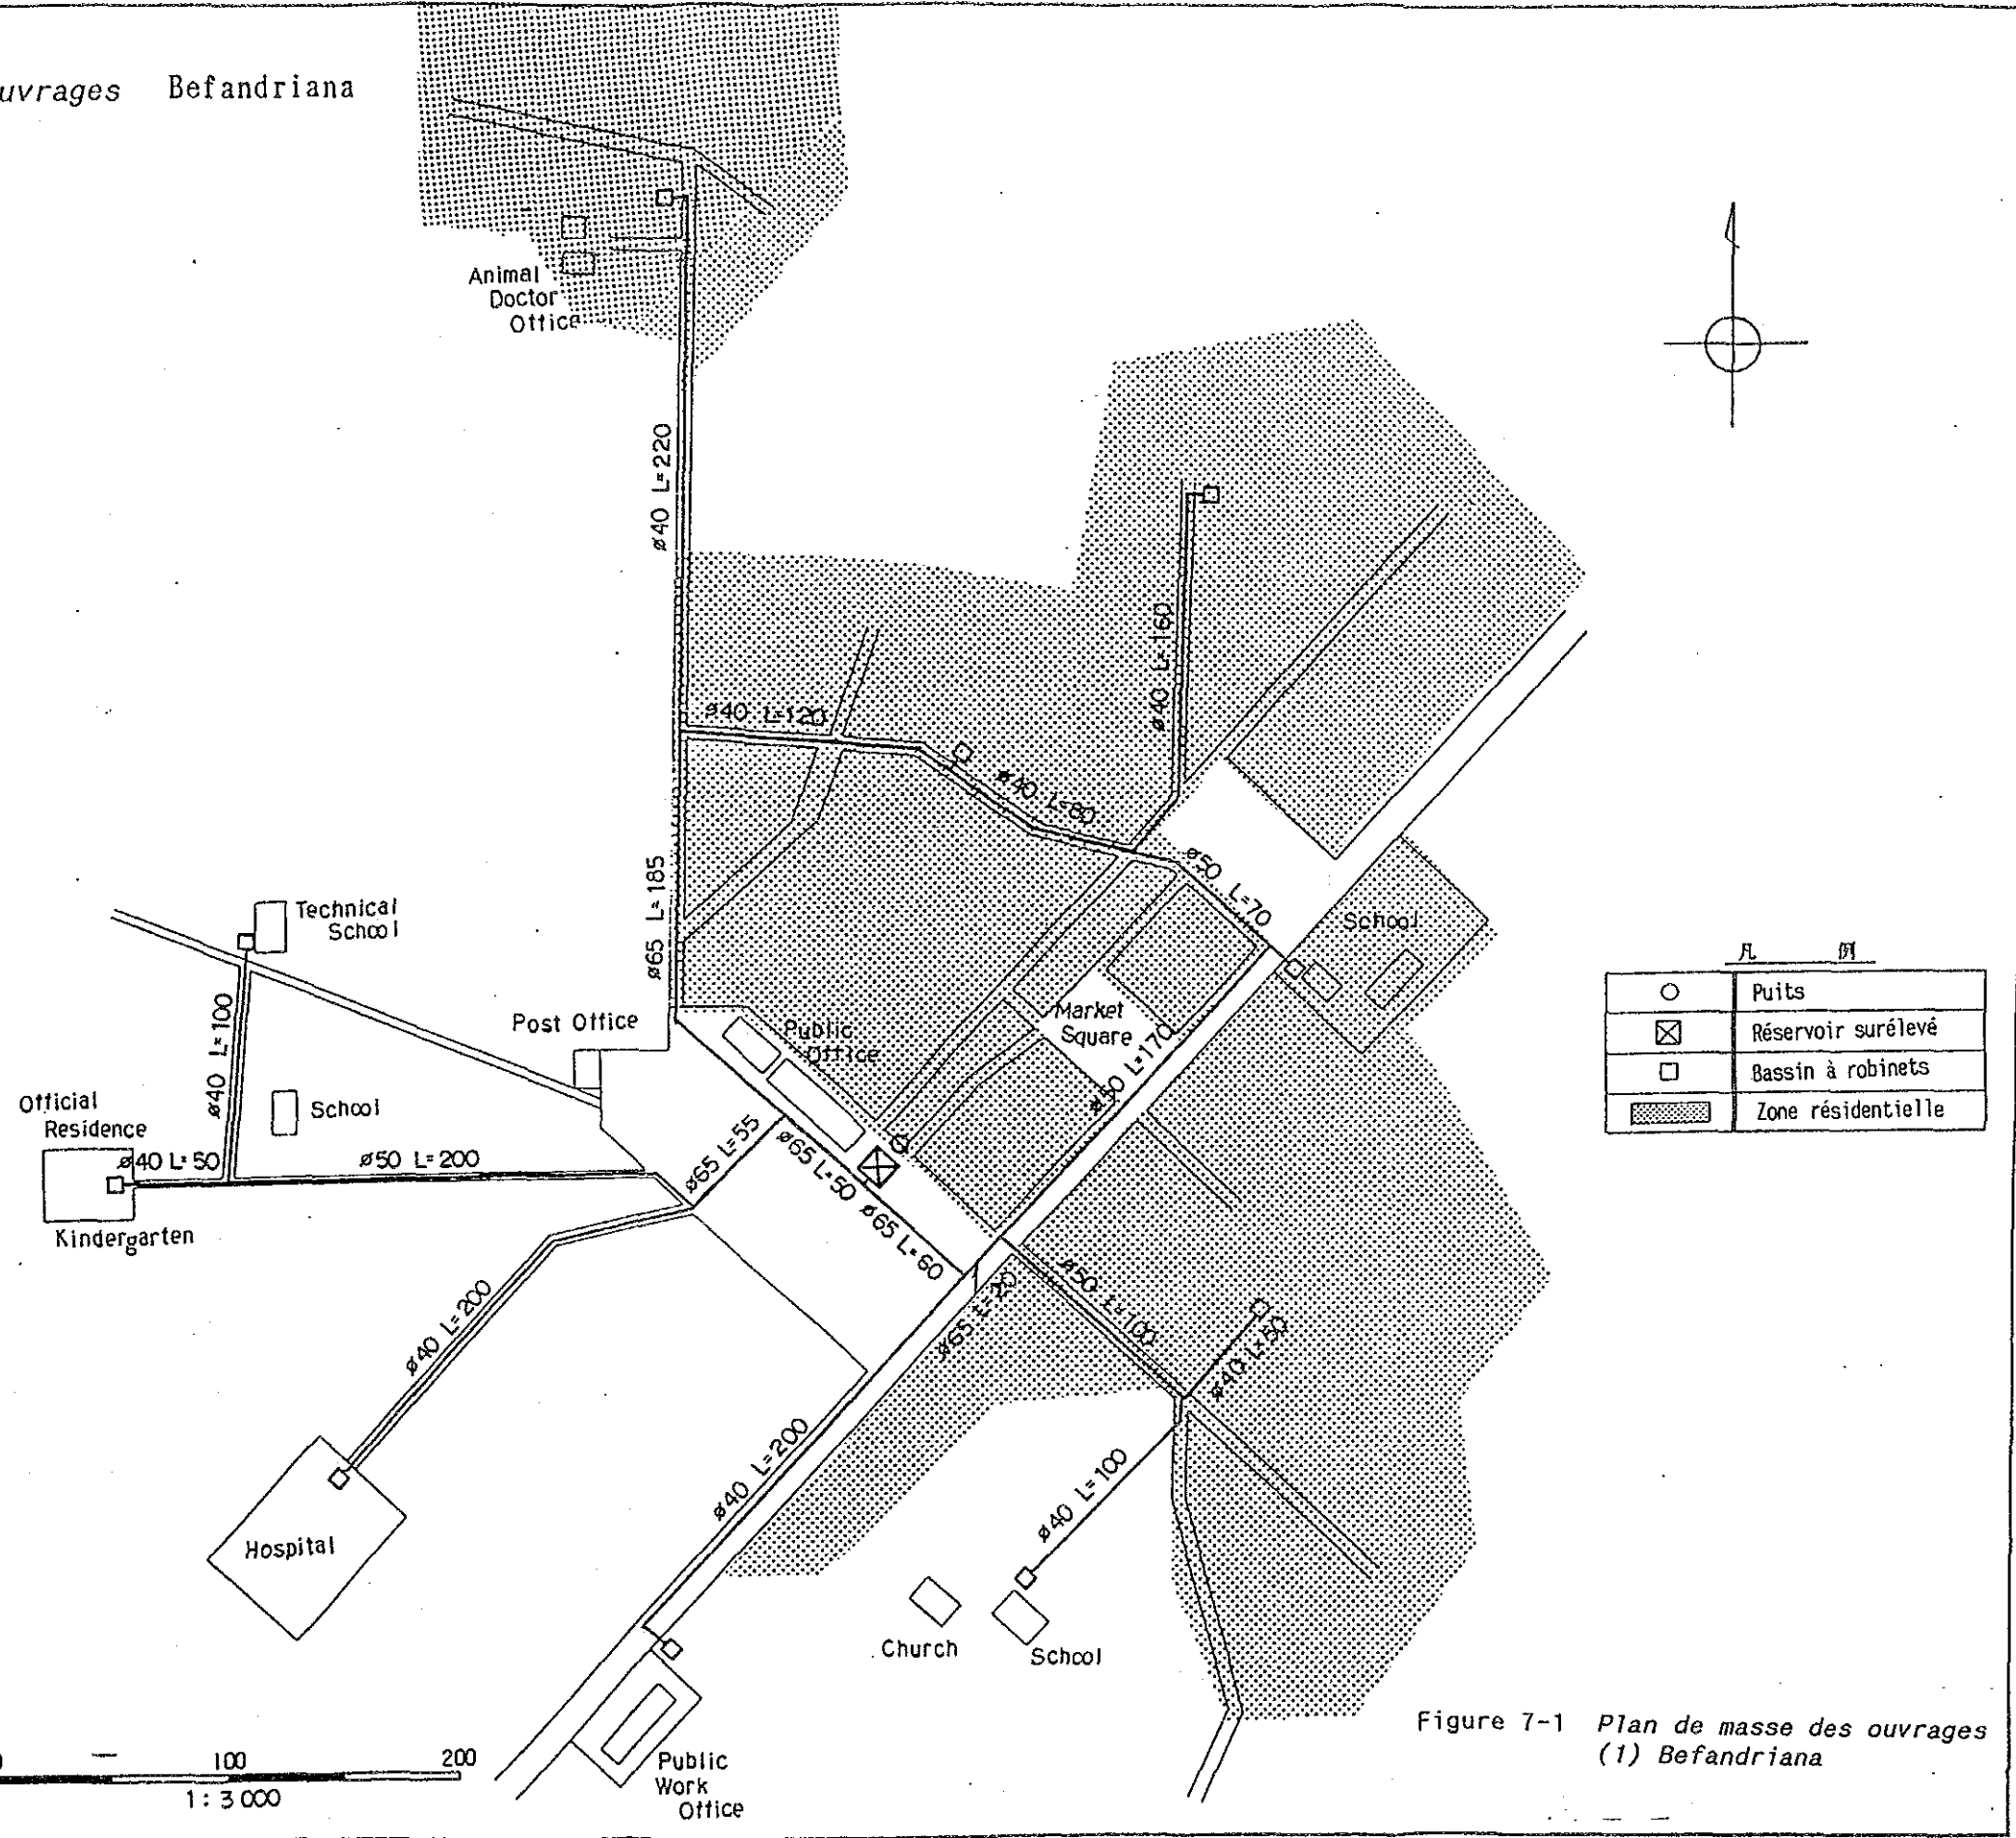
Plan de masse des ouvrages (1) Befandriana
